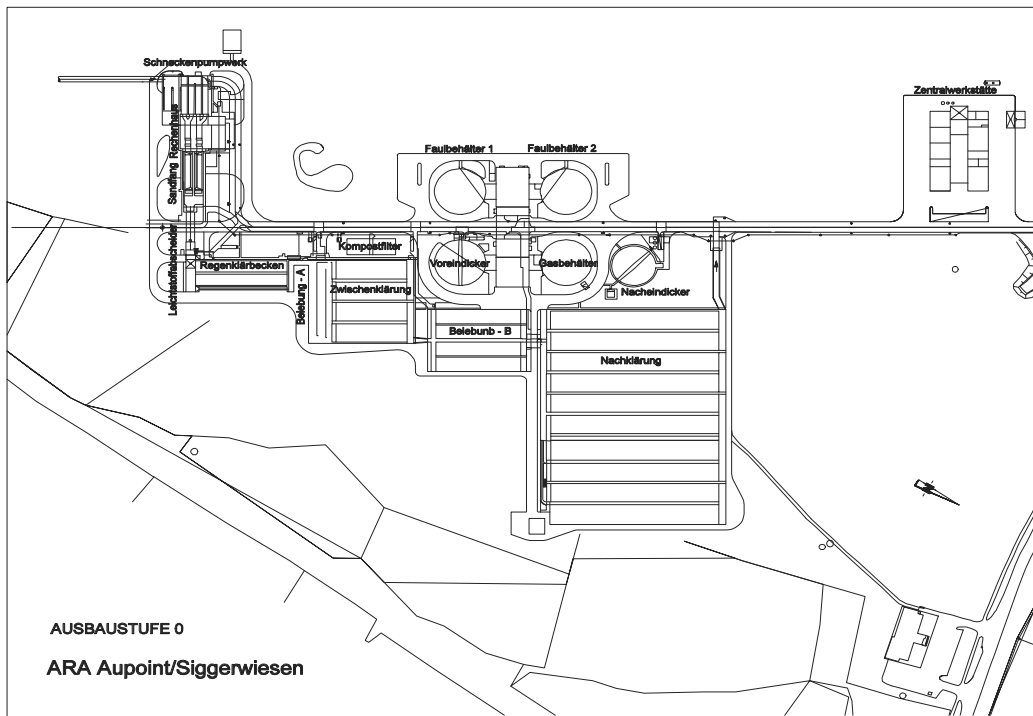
Lageplan Bestand 1986 - 1996 für 350.000 E (inkl. Ausbaustufe 1a)
